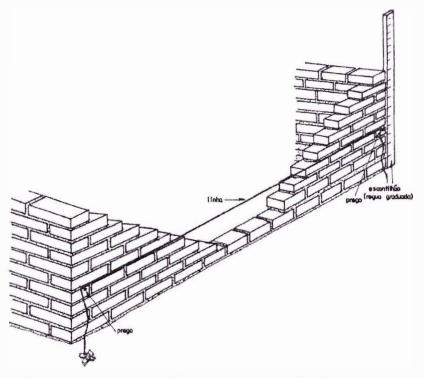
Detalhe do nivelamento da elevação da alvenaria.
